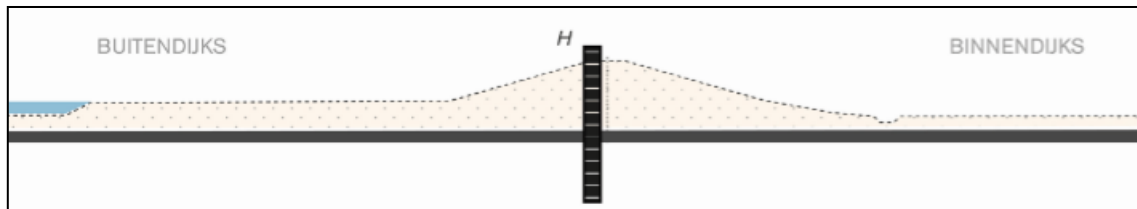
Verschuiving in buitendijkse richting met buitendijkse klei-ingraving of verticale pipingvoorziening
